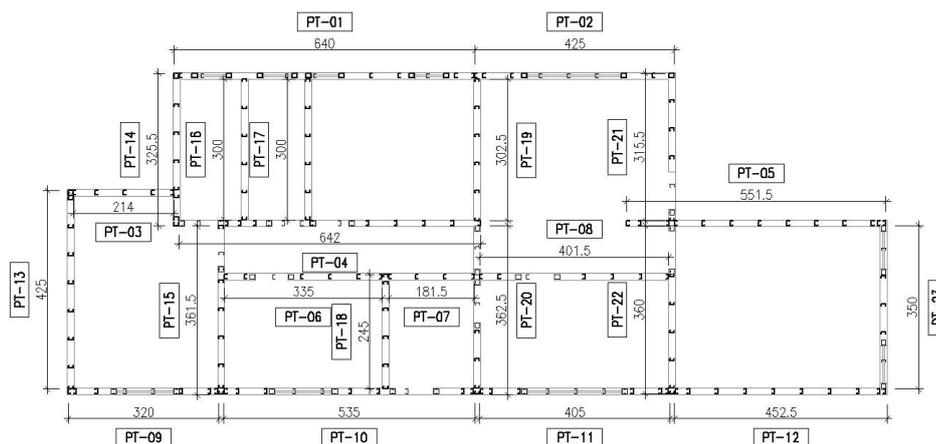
PLANTA BAIXA DA ESTRUTURA DE STEEL FRAME
